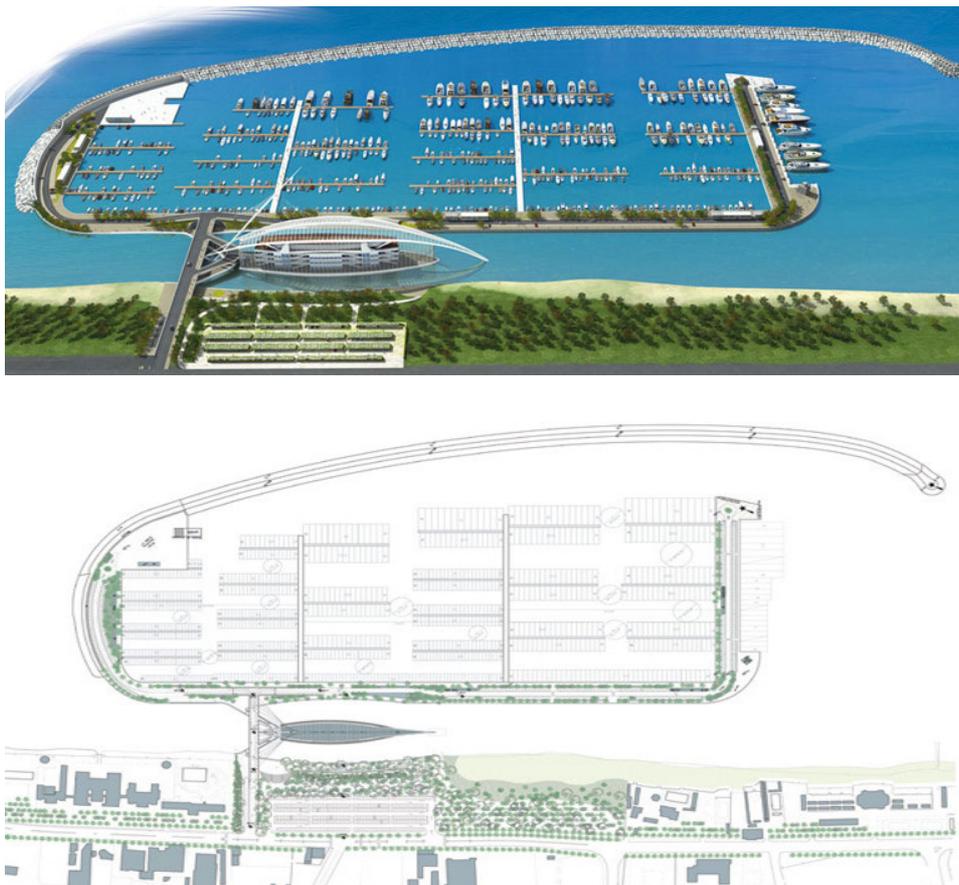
Marina d'Arechi, terza ipotesi progettuale: rendering e impianto planimetrico
